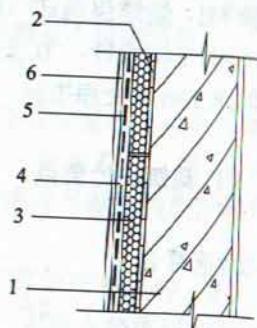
热桥、剪力墙保温构造基本构造
